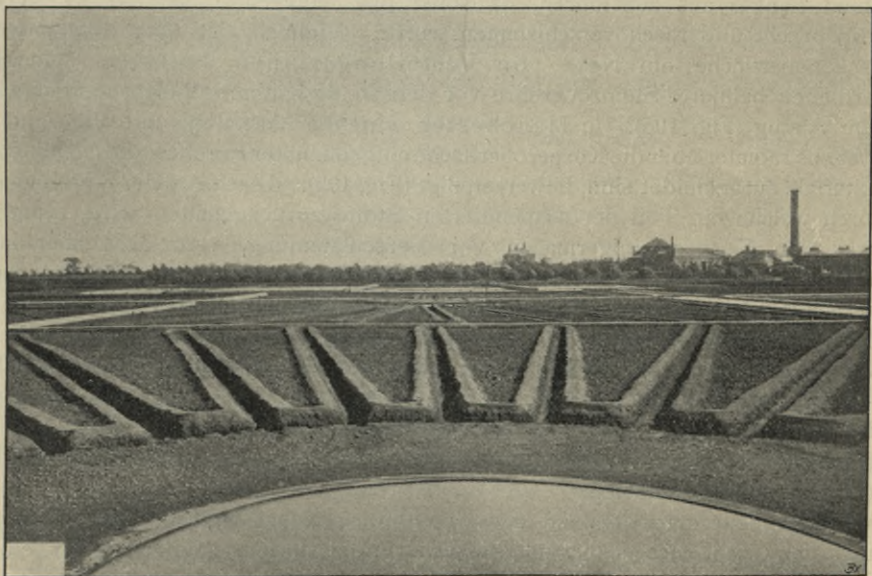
Füllkörper mit Furchen zur Abwasser-Verteilung in Manchester.
